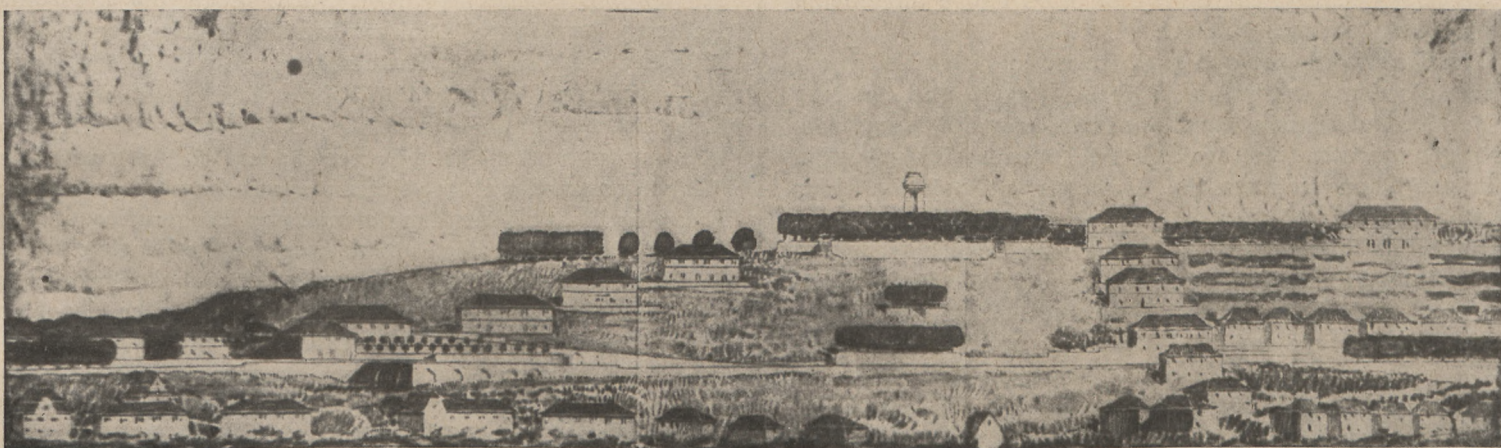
Bebauungsplan Azenberg südlich des Bismarckturms, Stuttgart.
